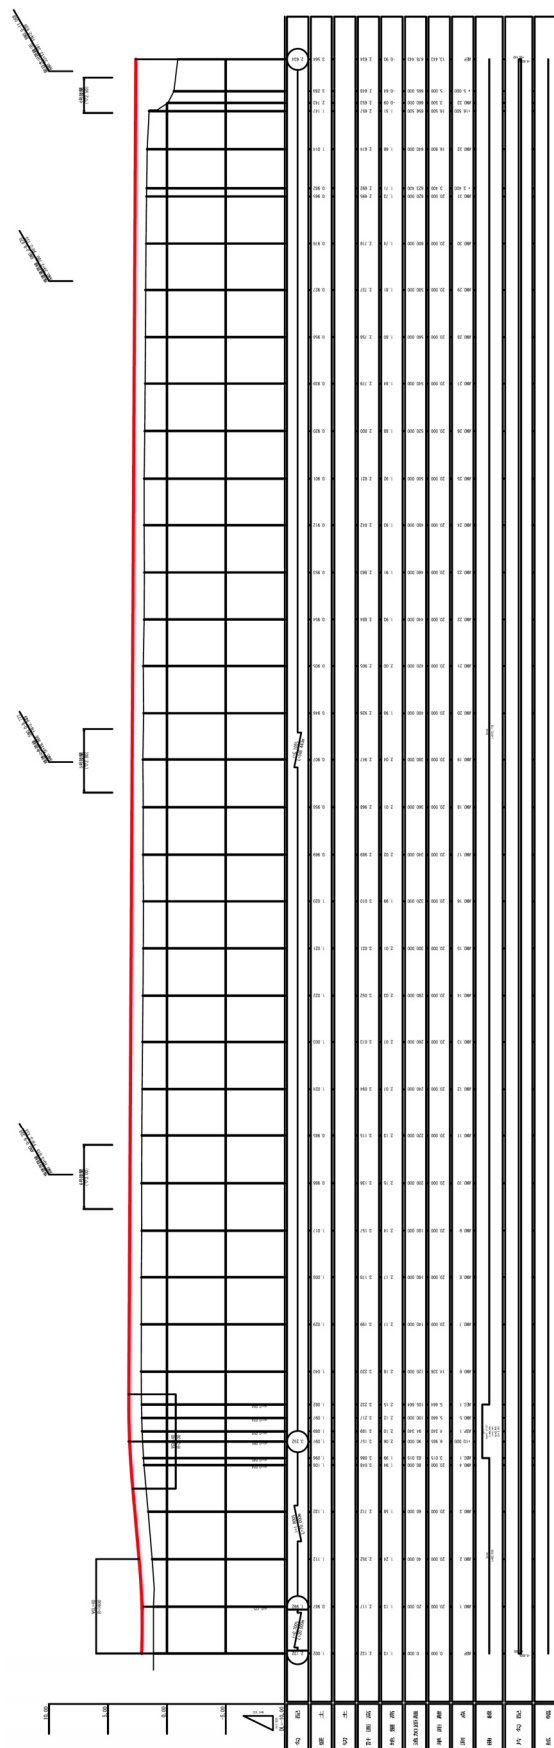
No.1 朝日大川路線平面図 (復旧後)
